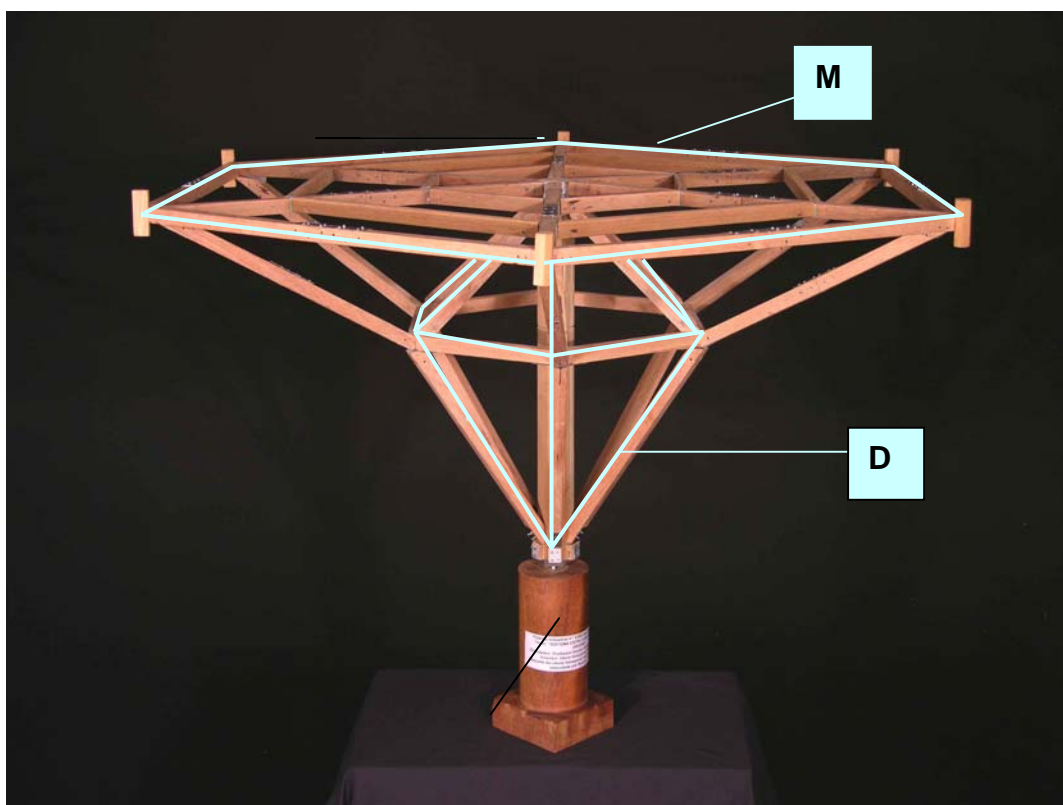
Módulo(M) e “diamante” de apoio (D)
